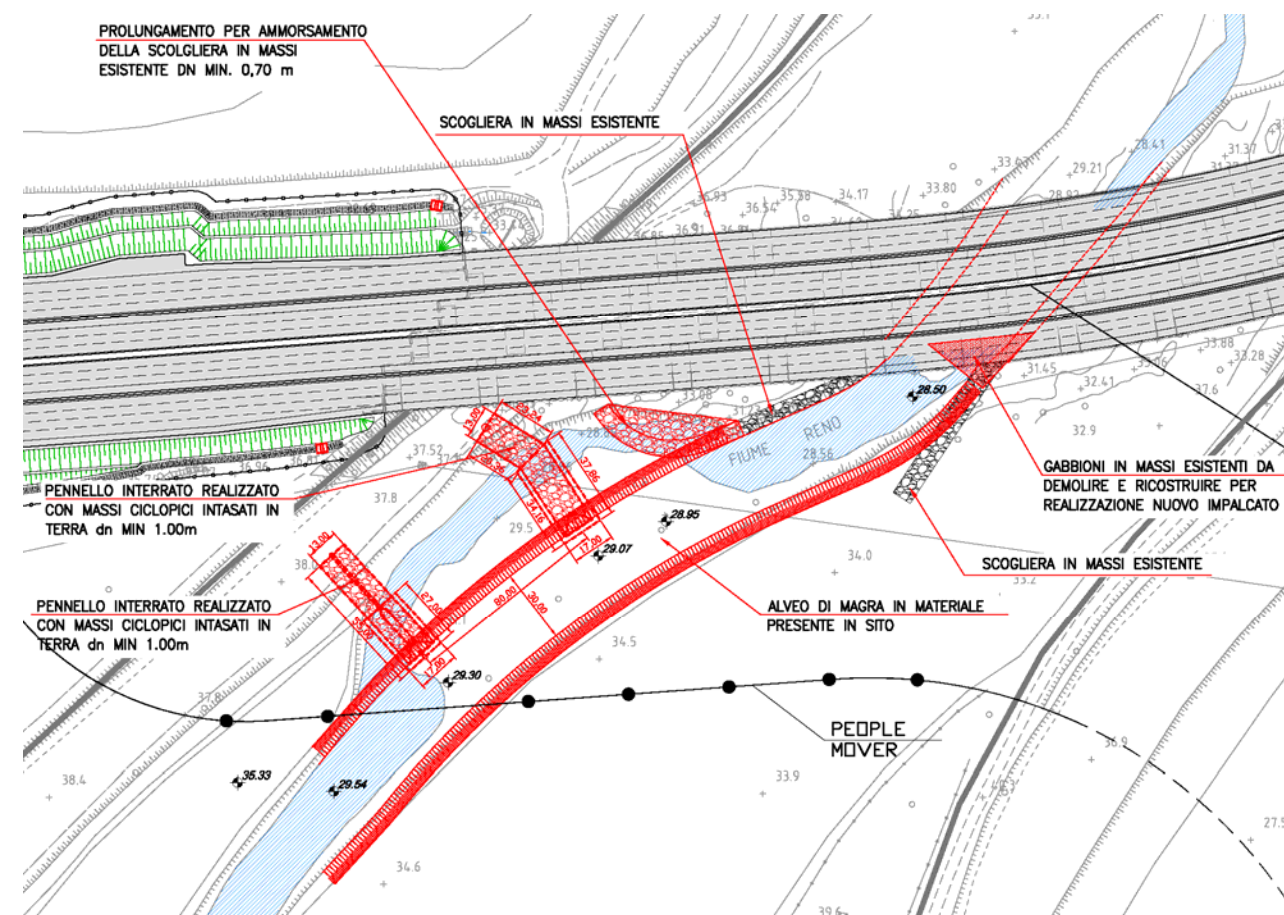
Planimetria di progetto di sistemazione dell'alveo di magra del fiume Reno (fonte: *Progetto definitivo – Relazione Idrologica e idraulica*)
